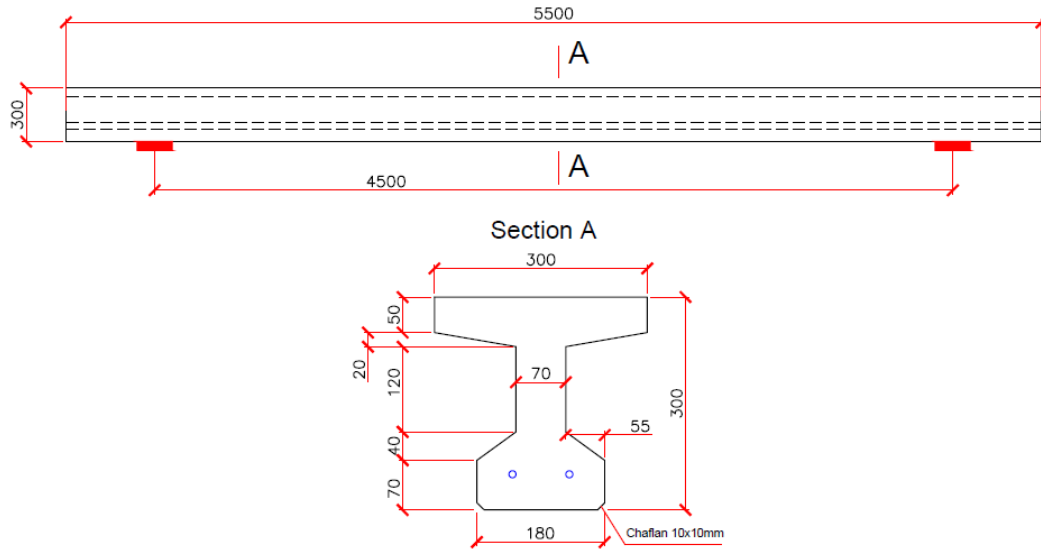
Dimensiones de las vigas de la campaña experimental con armadura activa. G. ORTIZ, (2020)
